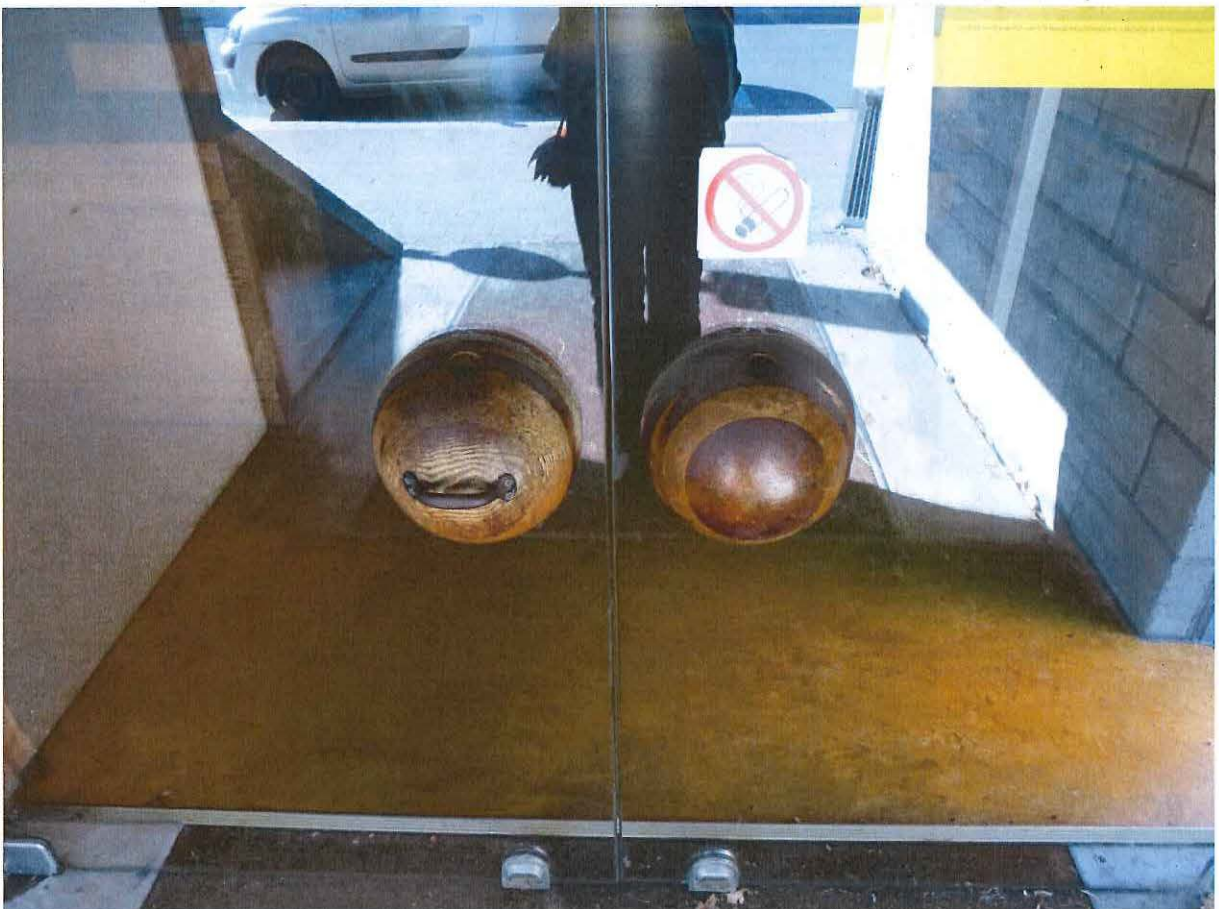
Voorgevel hoofdgebouw. Detail van de houten handvaten opgebouwd uit 2 halve bollen aan iedere zijde van de deur, met later aangebrachte metalen greep.
